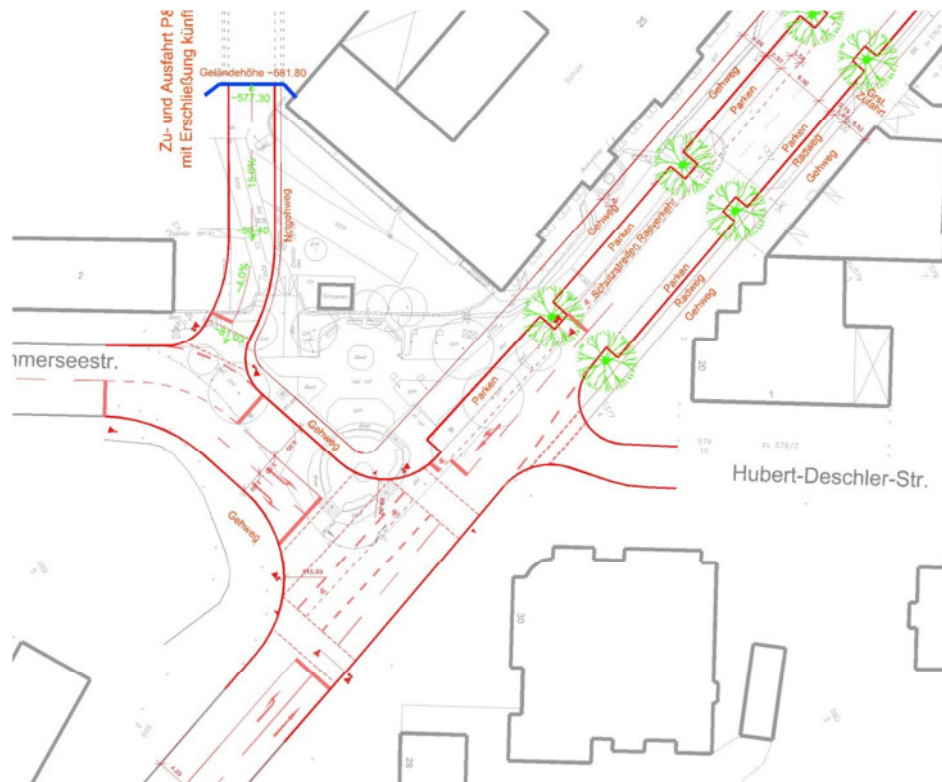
Lageplan zum Ausbau/Umbau der Kreuzung Ammerseestraße / Bahnhofstraße / P+R-Zufahrt
